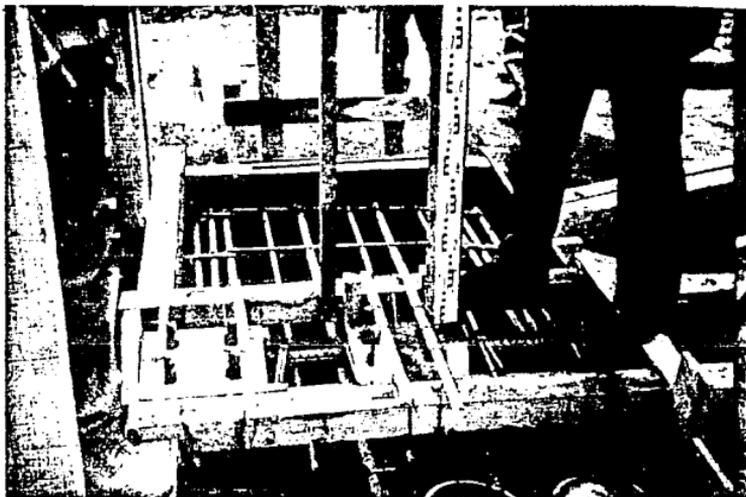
VERIFICACION DE NIVELES EN DADOS DE CIMENTACION, DONDE SE ANCLARAN LAS COLUMNAS METALICAS
